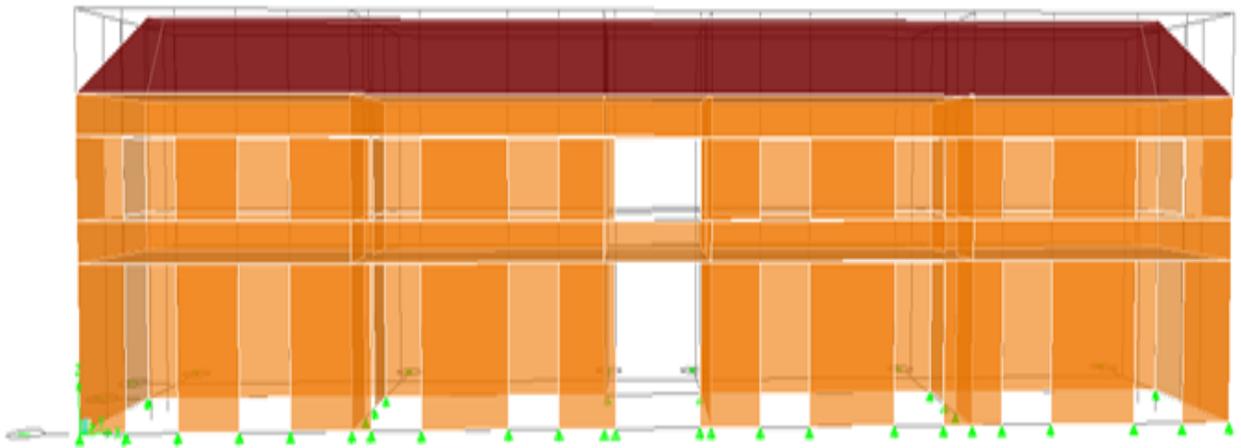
Geometría del Modelo de Muros y Cobertura.
